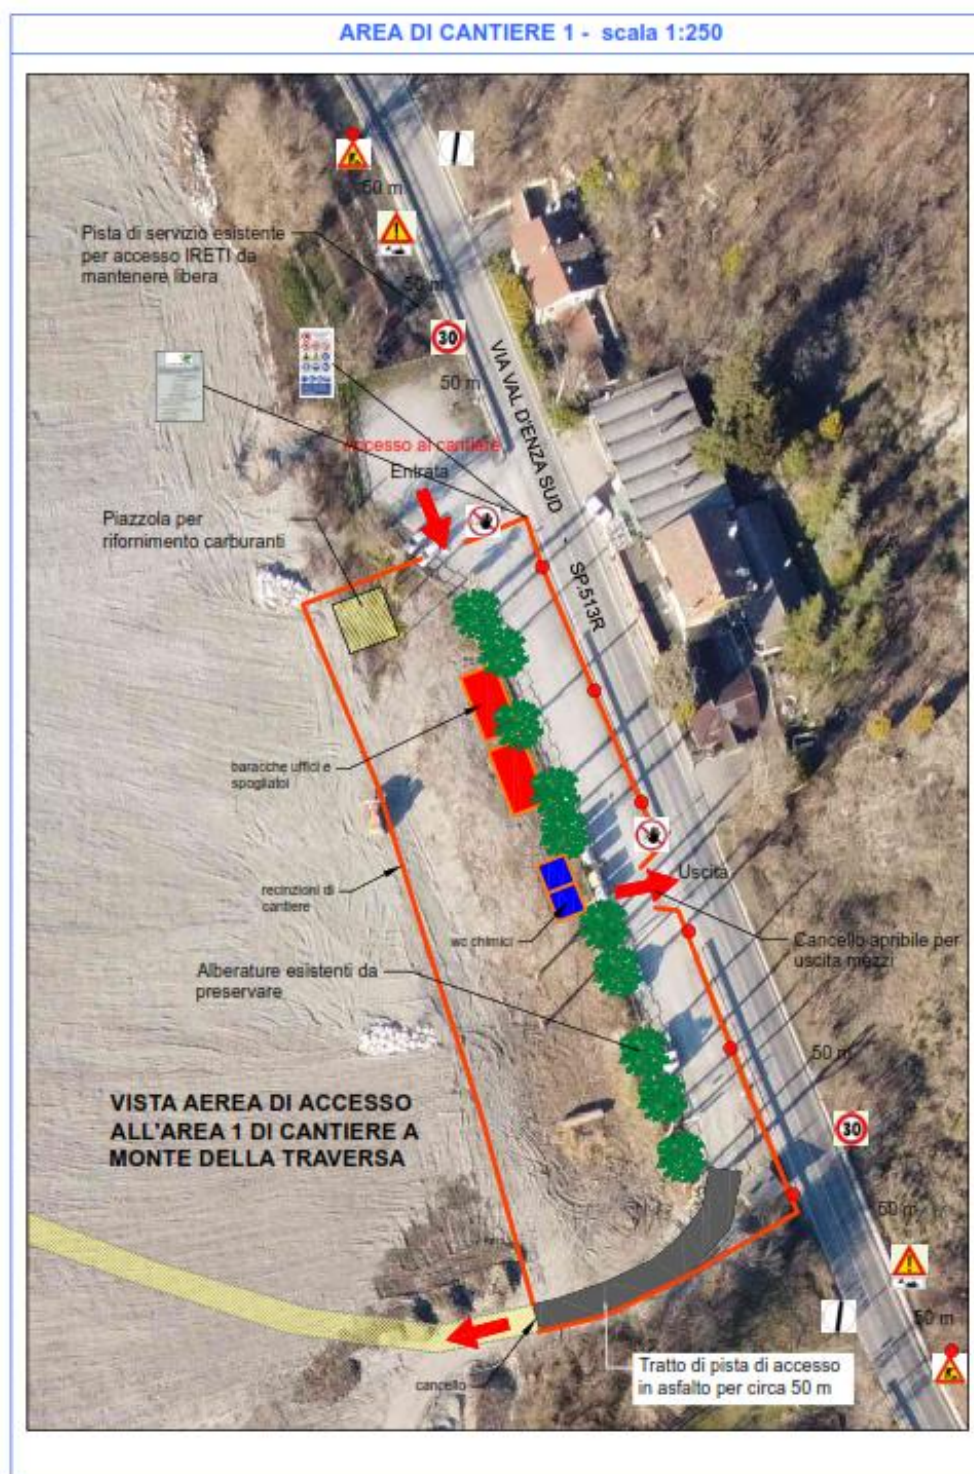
lay out di area di cantiere 1 estratto da tavola di progetto 4.1
